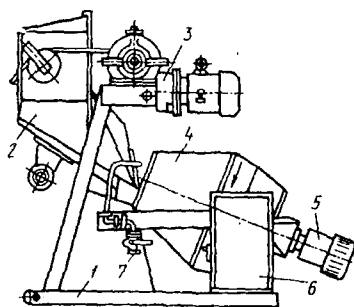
Бетоносмеситель СБ-16Б: 1 – рама; 2 – загрузочный ковш; 3 – привод загрузочного ковша; 4 – смесительный барабан; 5 – привод смесительного барабана; 6 – электрощкаф; 7 – система дозирования.
